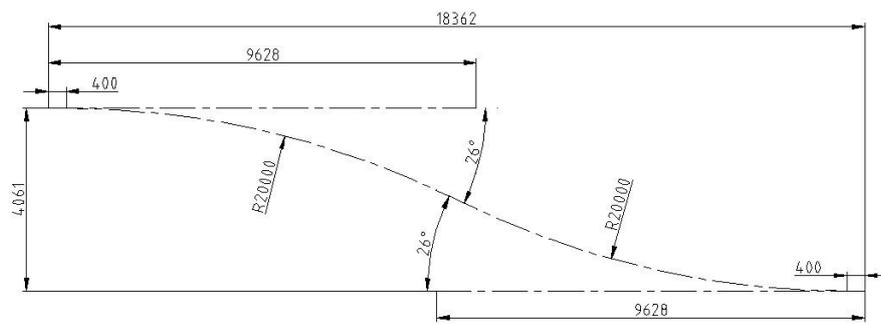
平移型单渡道岔线型(尺寸单位: mm)
